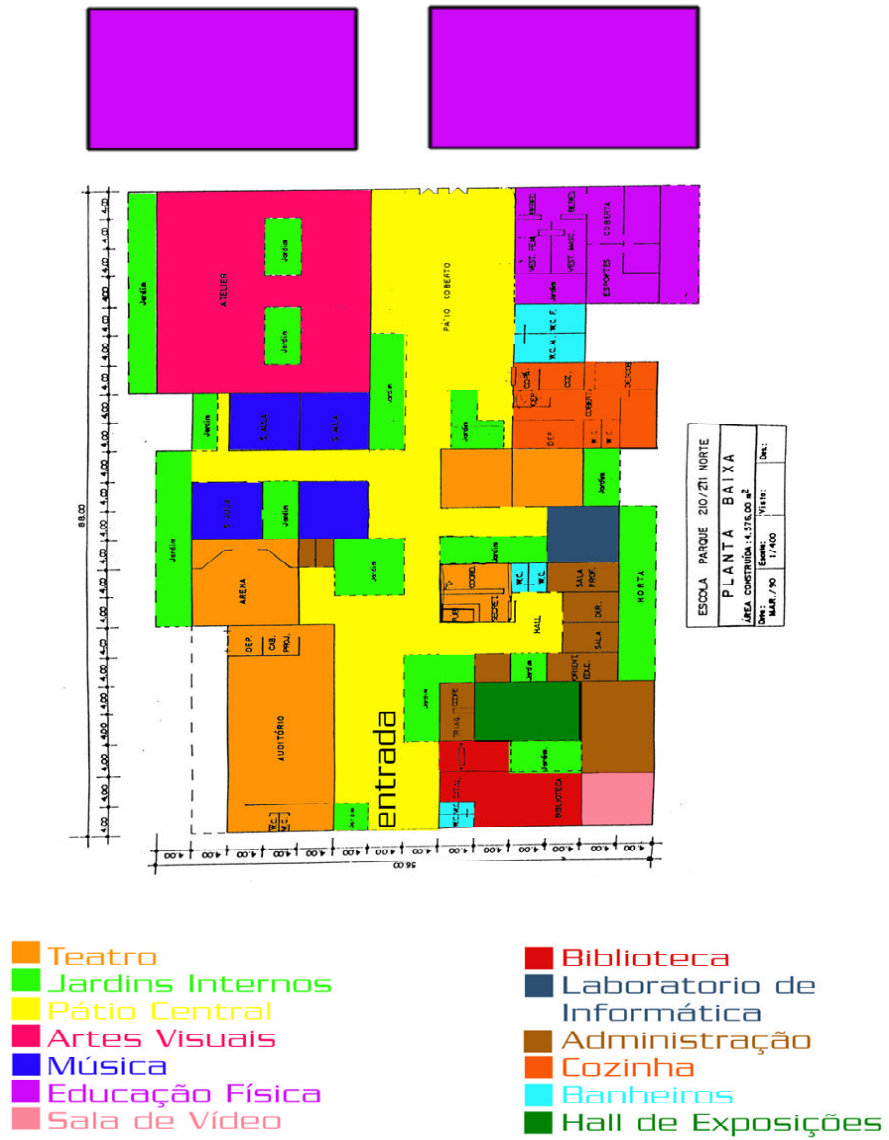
Planta baixa da Escola-Parque 210/211 Norte.
